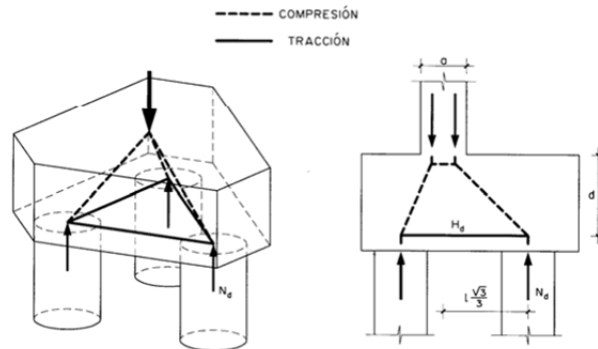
Modelo para encepado sobre tres pilotes
